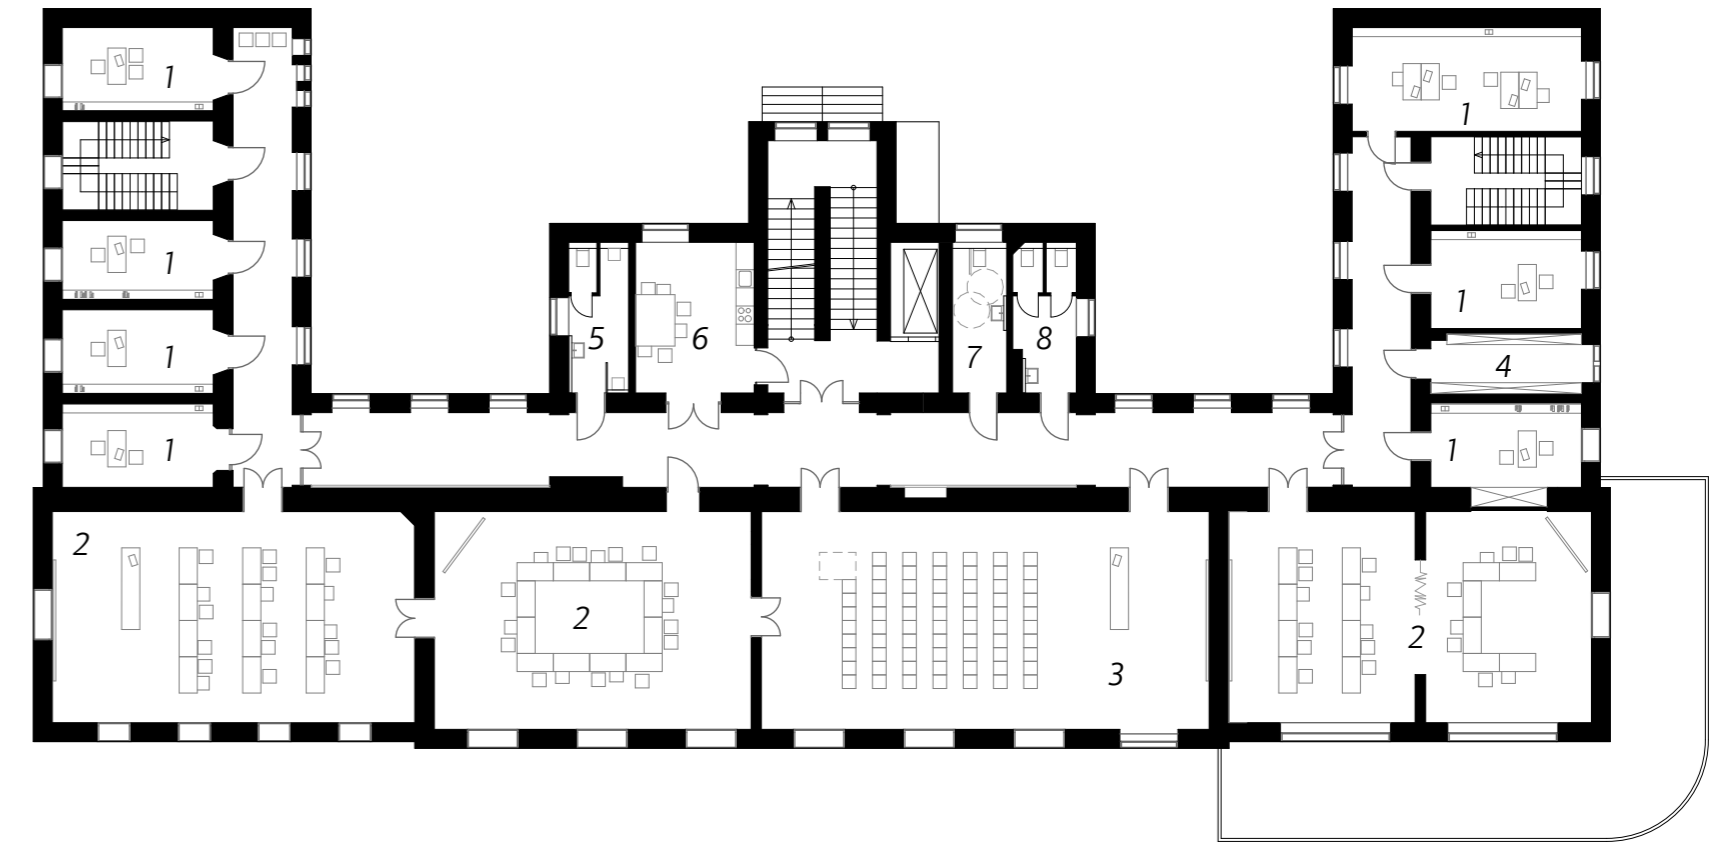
Umbaumaßnahmen Pavillon 12 | Erdgeschoss | M 1-250
